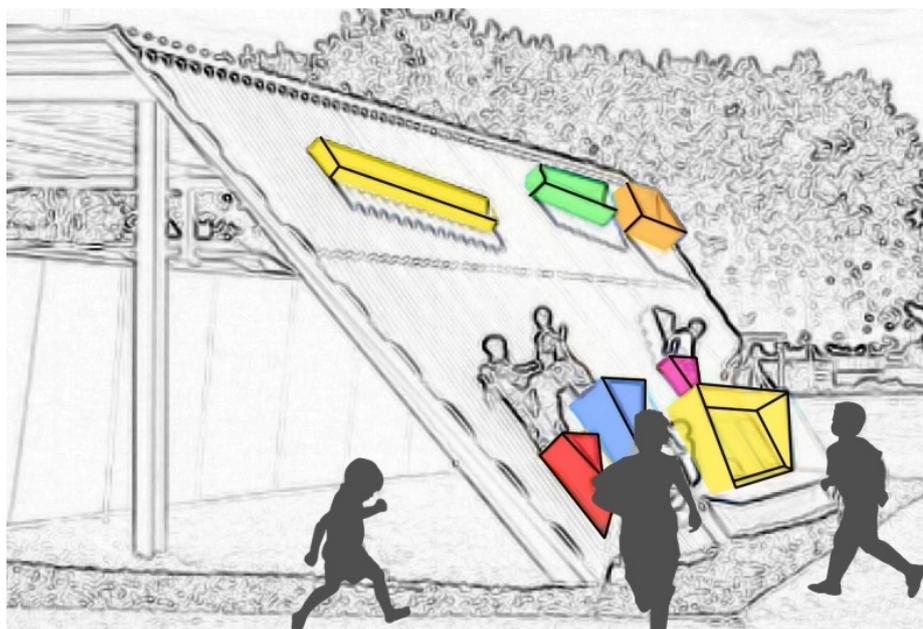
Фрагмент фасада здания ДОУ со сменными игровыми элементами
